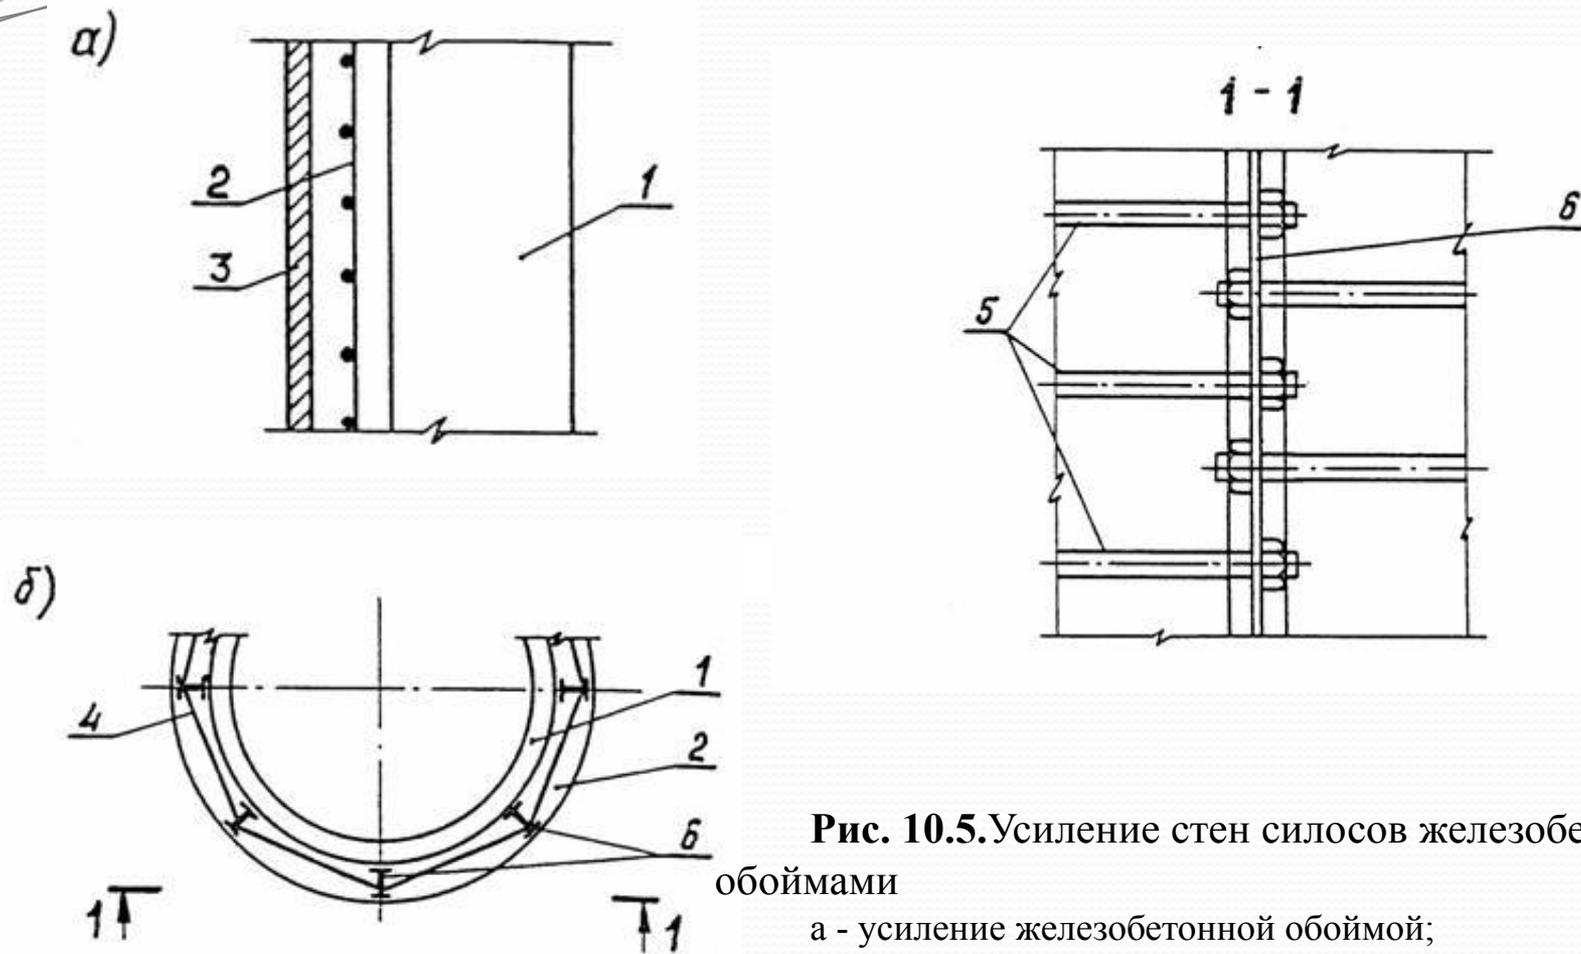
Усиление стен силосов железобетонными обоймами
